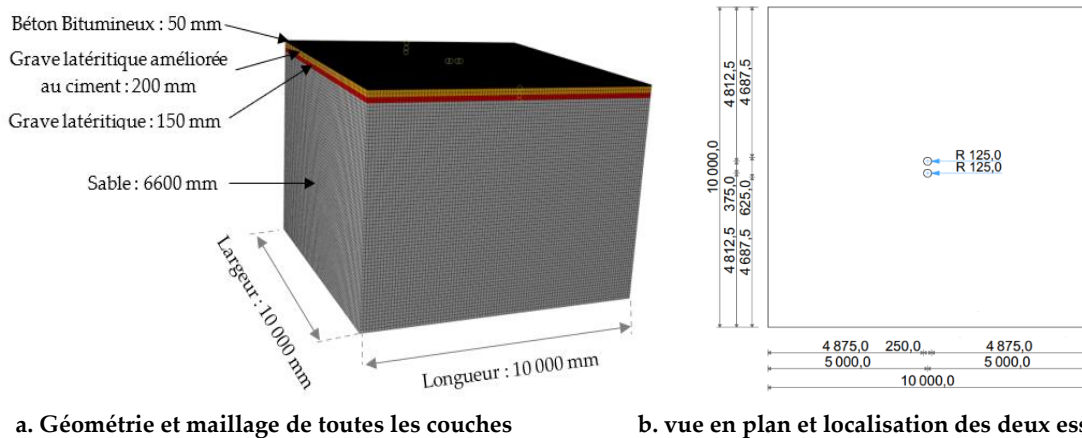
Géométrie, maillage de toutes les couches et chargement de la chaussée
